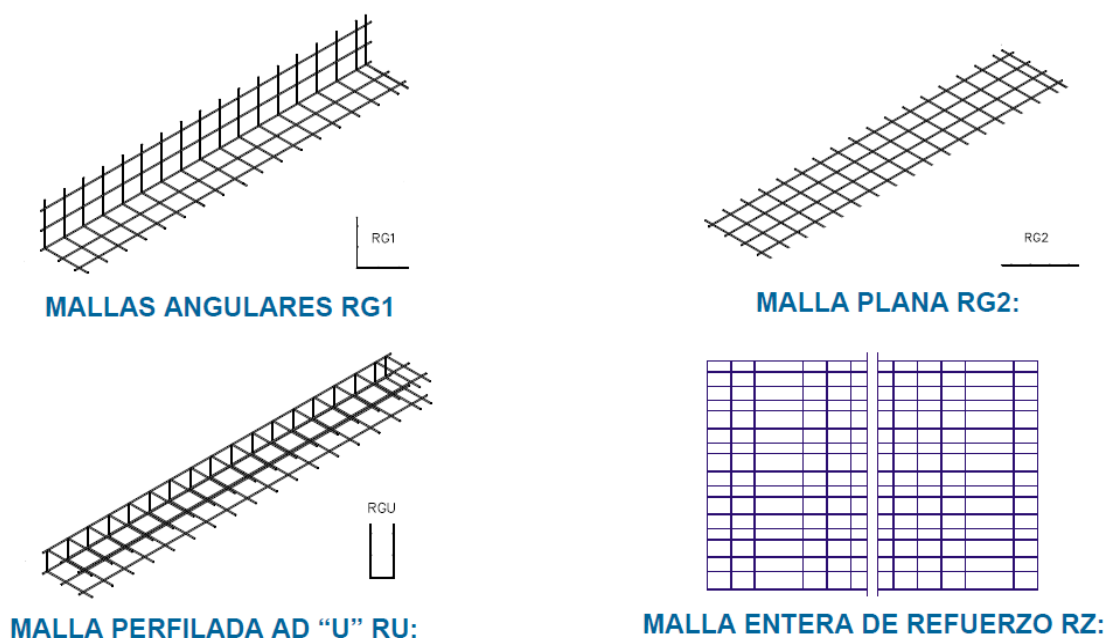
Tipos de mallas de refuerzo. Emmedue (2008). Mallas de refuerzo. Recuperado de <http://www.mdue.it>
